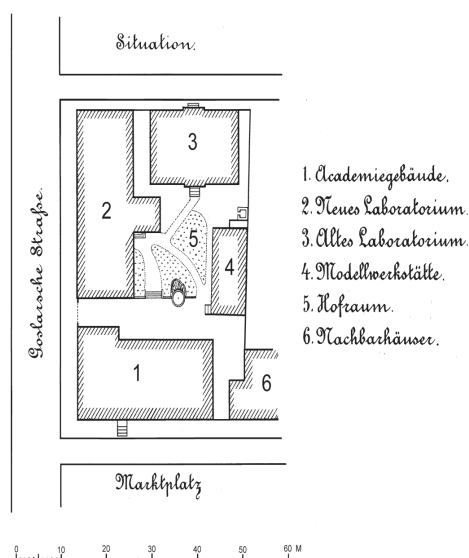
Lageplan der Gebäude der Bergakademie (um 1880).
